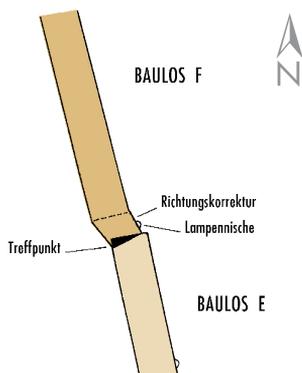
Detail: Treffpunkt Baulos E und F. M. 1:100
